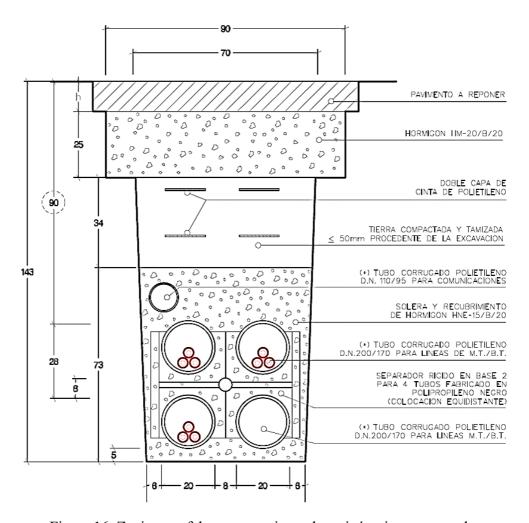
Zanja en asfalto, aparcamiento, hormigón, tierra y acerado.
